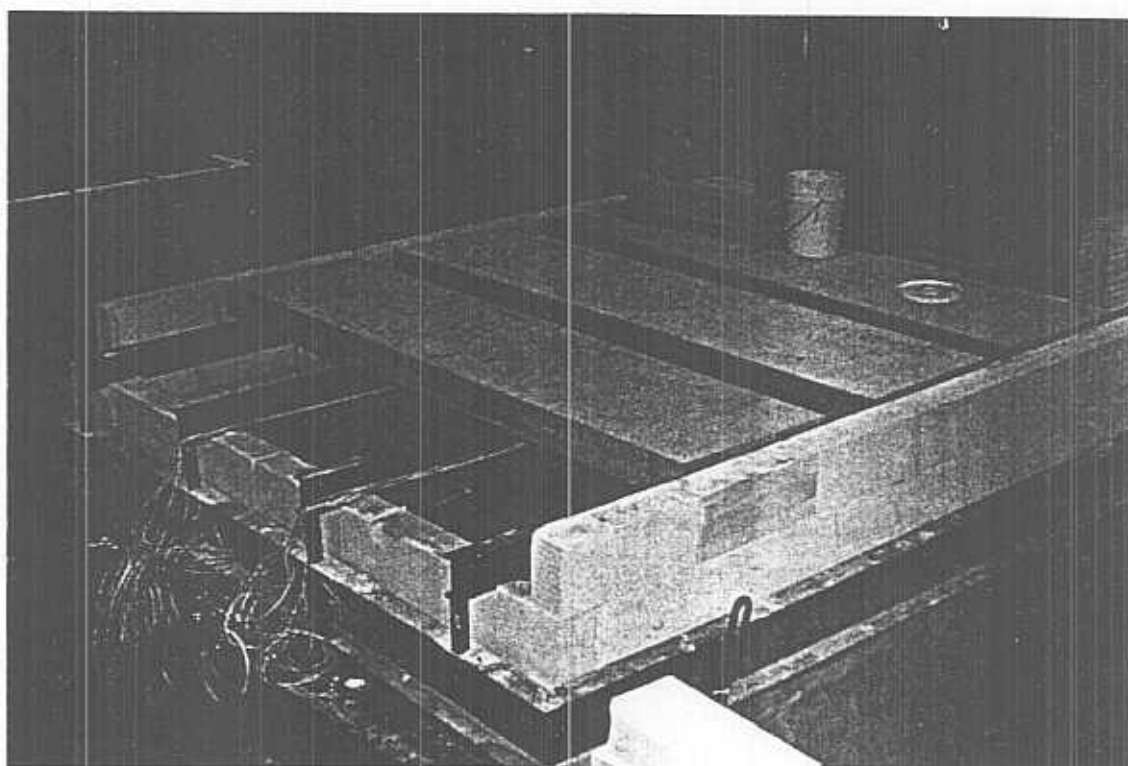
Bovenaanzicht vloer/plafond constructie tijdens de opbouw.
